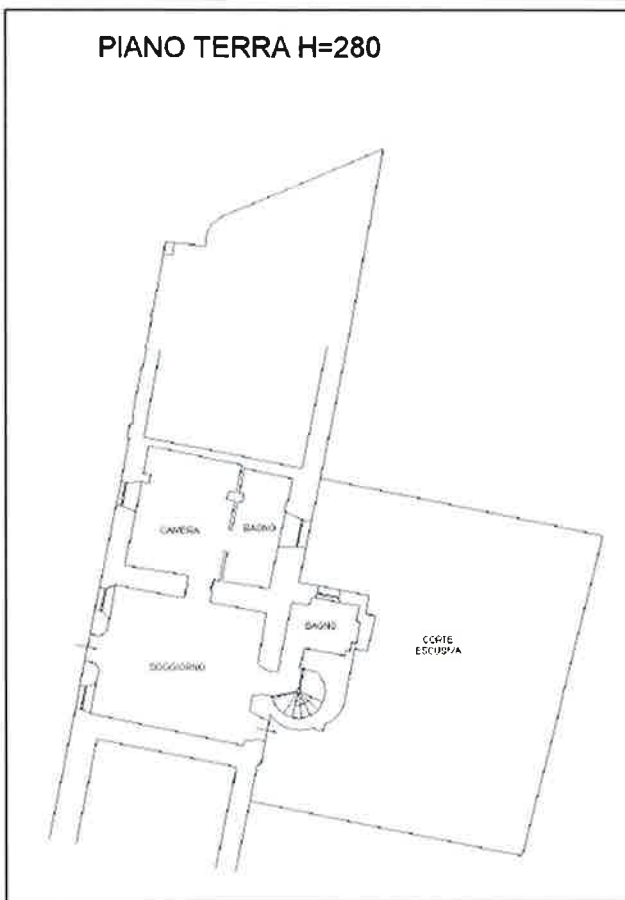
planimetria catastale dell'unità identificata con la particella 1184 sub 9
